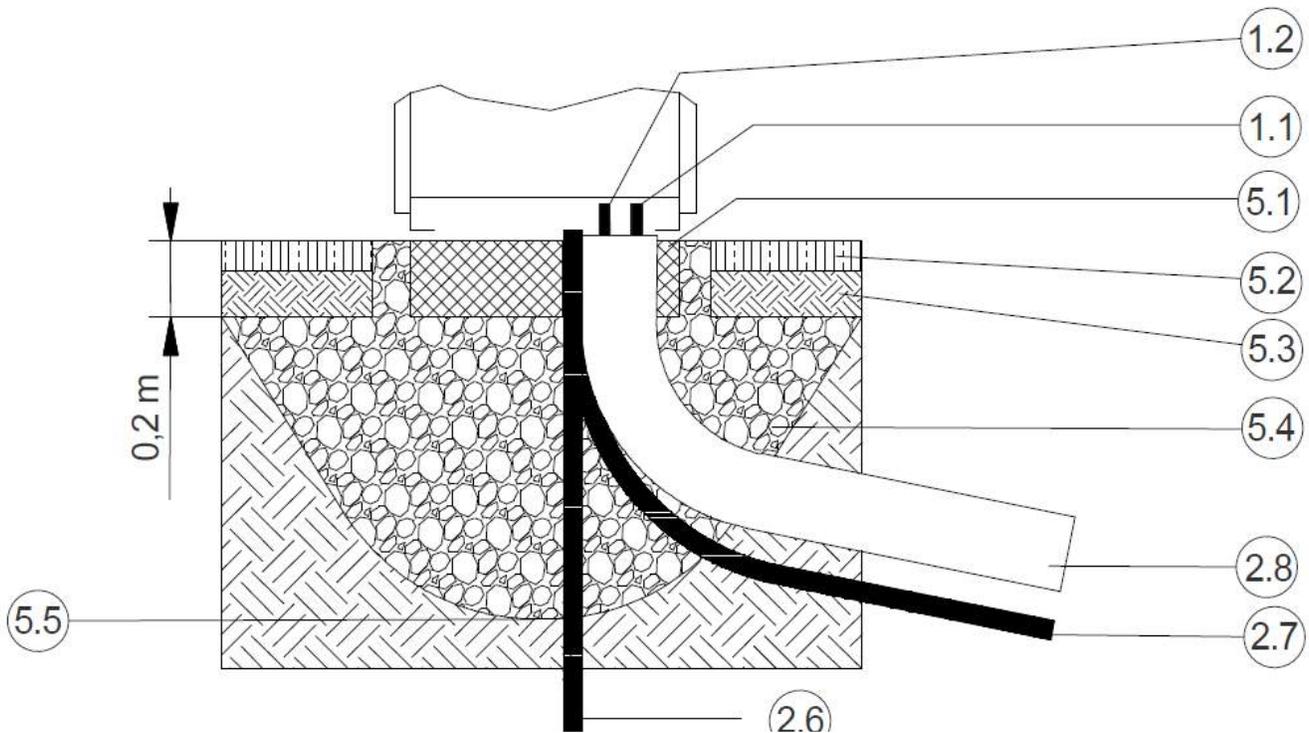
Fundamentplan M Flex und System M Comfort mit Kiesbett
